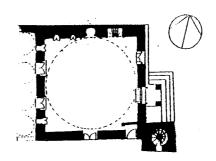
مسقط أفقى لمسجد حاجى محمد باشا فى يريم . (عن : خليفة) .
